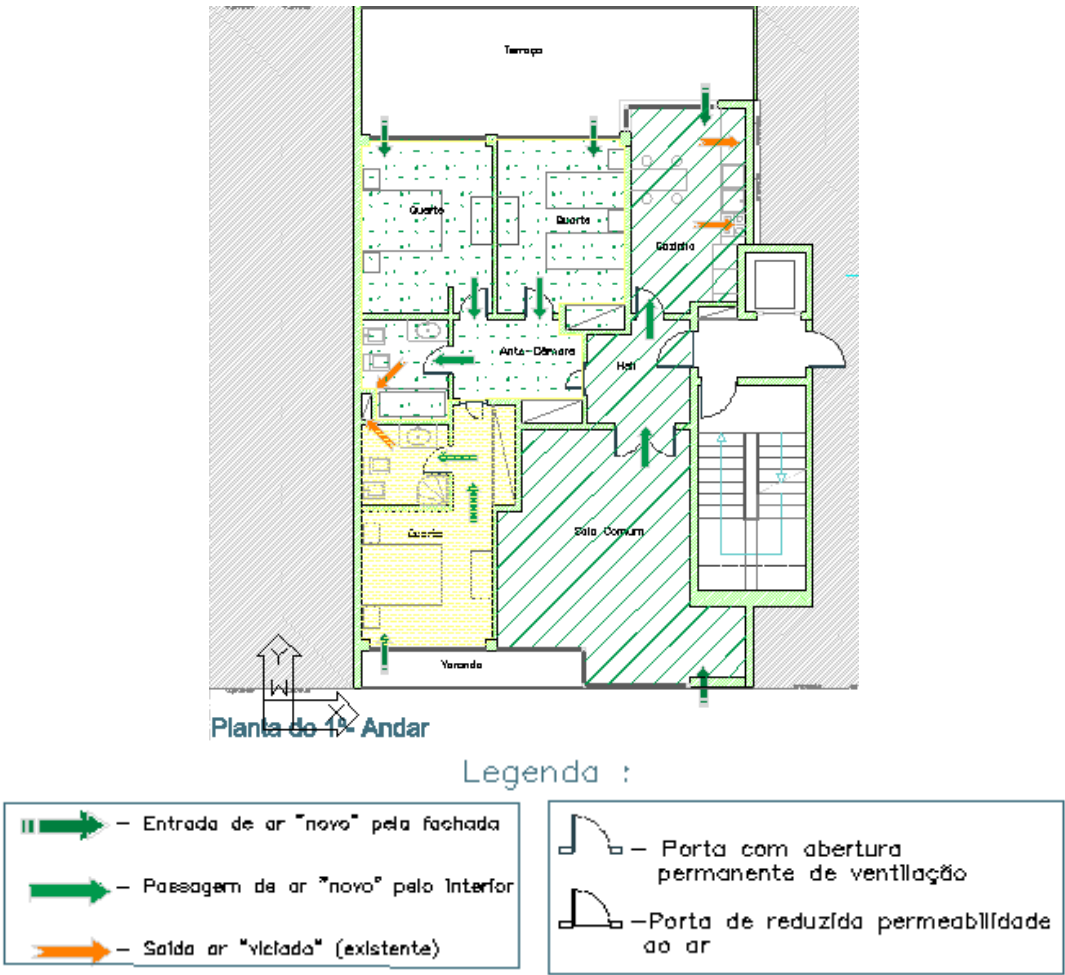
Planta do 1º andar esquerdo – esquema da ventilação natural
